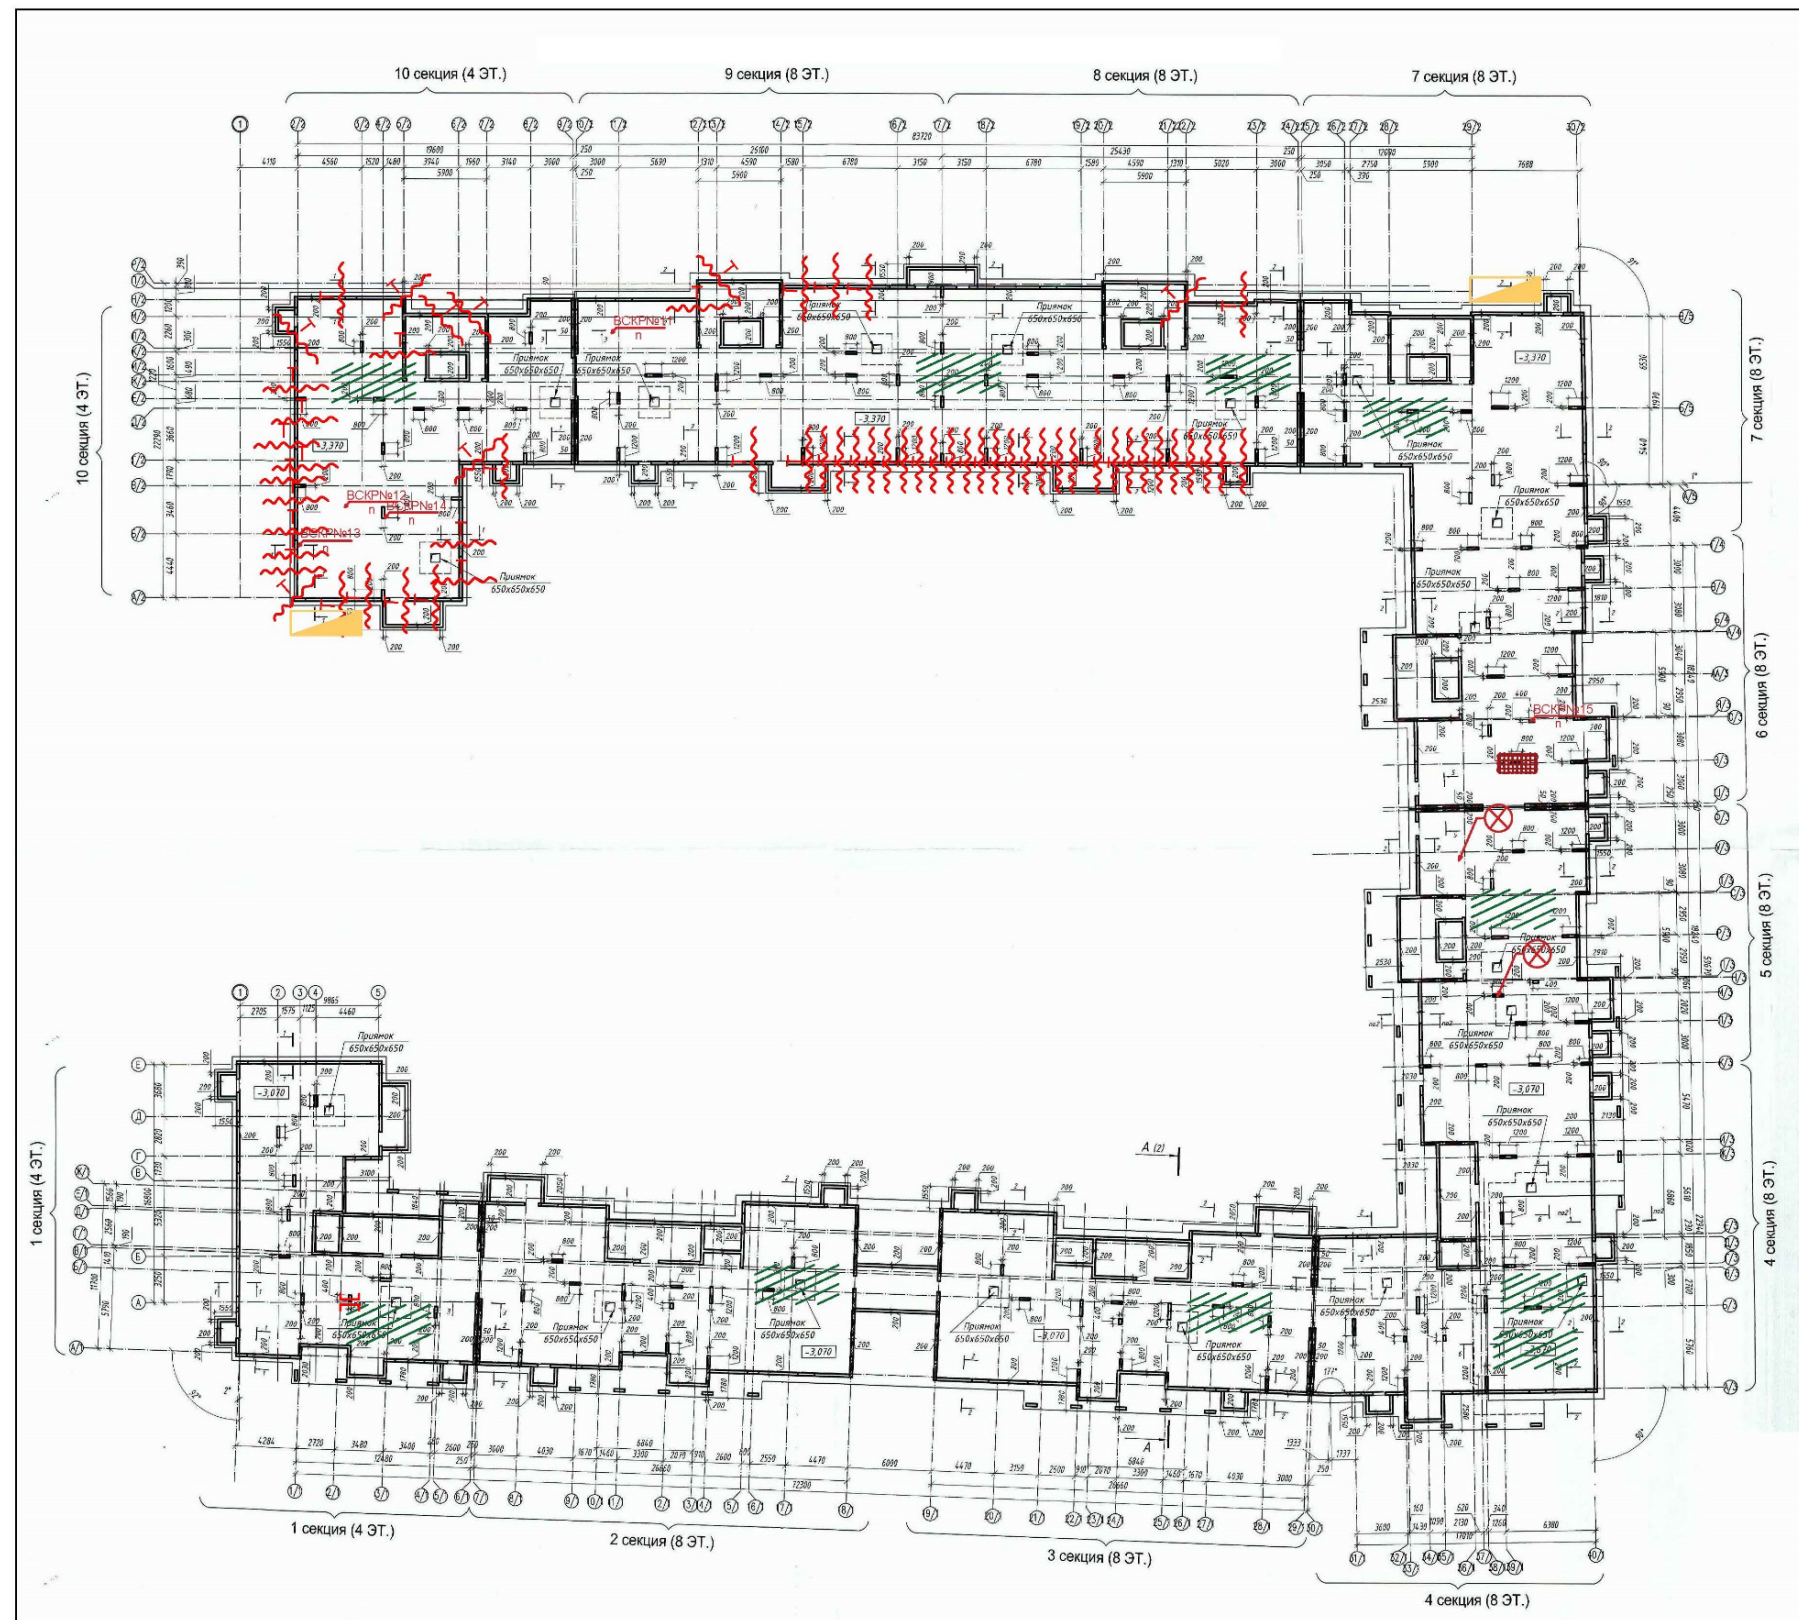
Карта дефектов фундаментной плиты и вертикальных конструкций подвала
